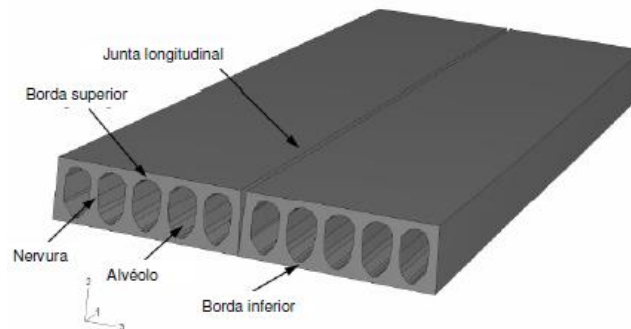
Juntas entre placas alveolares (Rettn e Edekling, 2006).
